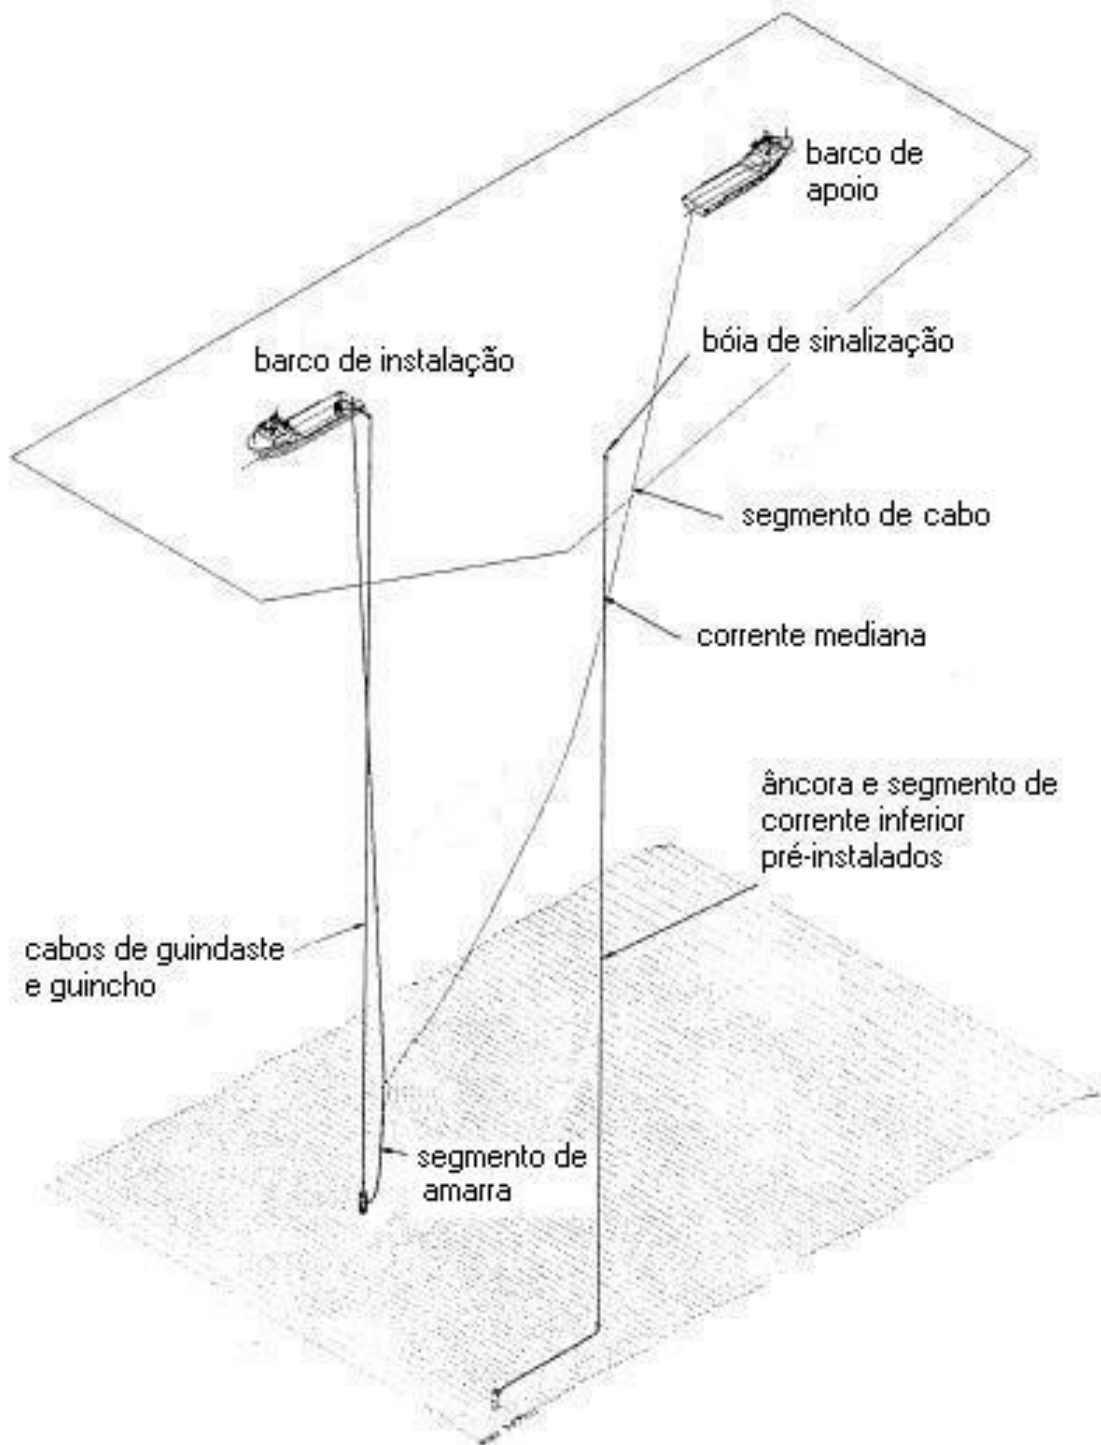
d. Instalação de Âncoras utilizando duas embarcações
